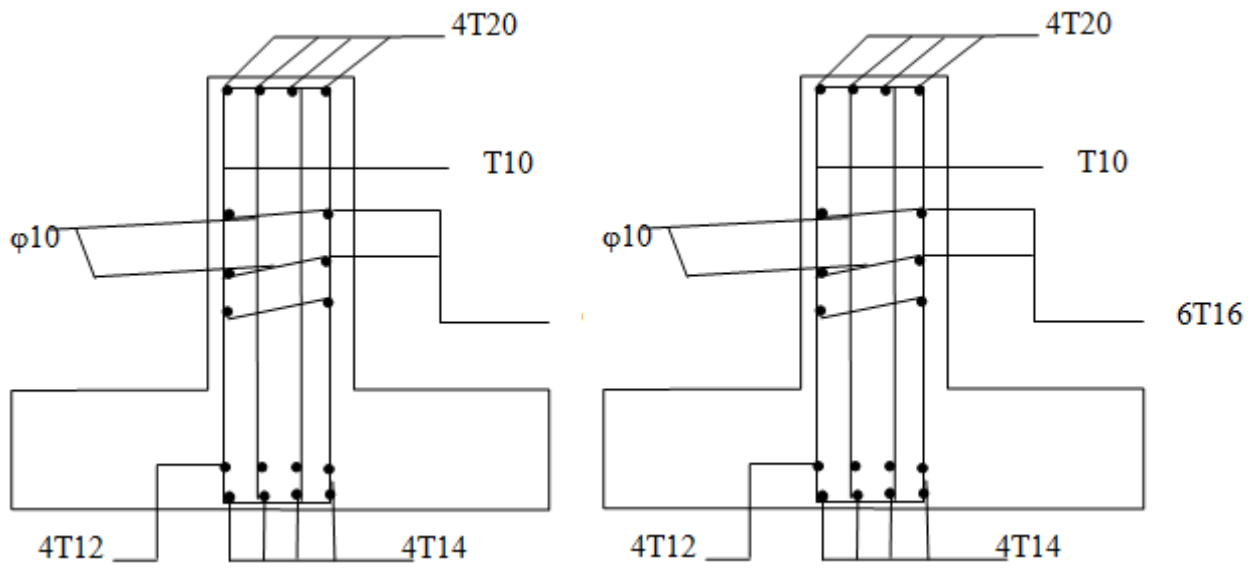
Ferrailage de la poutre principale. Figure VIII.13: Ferrailage de la poutre secondaire.
